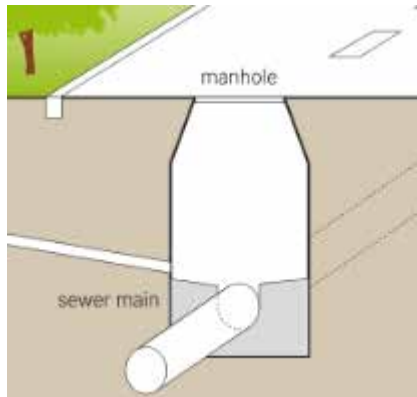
Alcantarilla, se observa su instalación bajo la calzada
